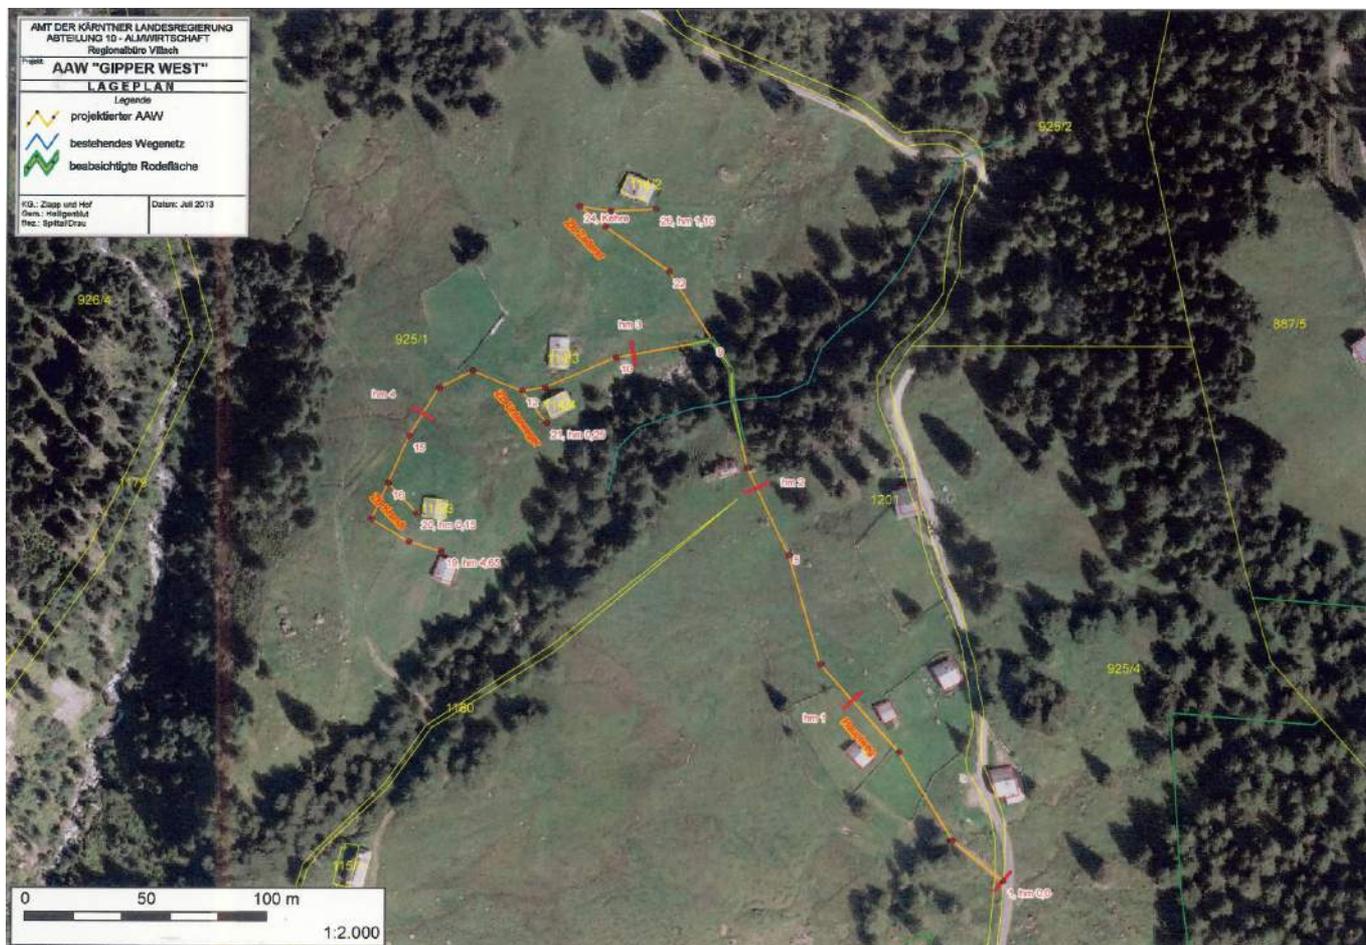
Lageplan mit Orthophoto – Darstellung der Grundstücksgrenzen und des Wegprojekts (© Friedrich Walter Merlin)
